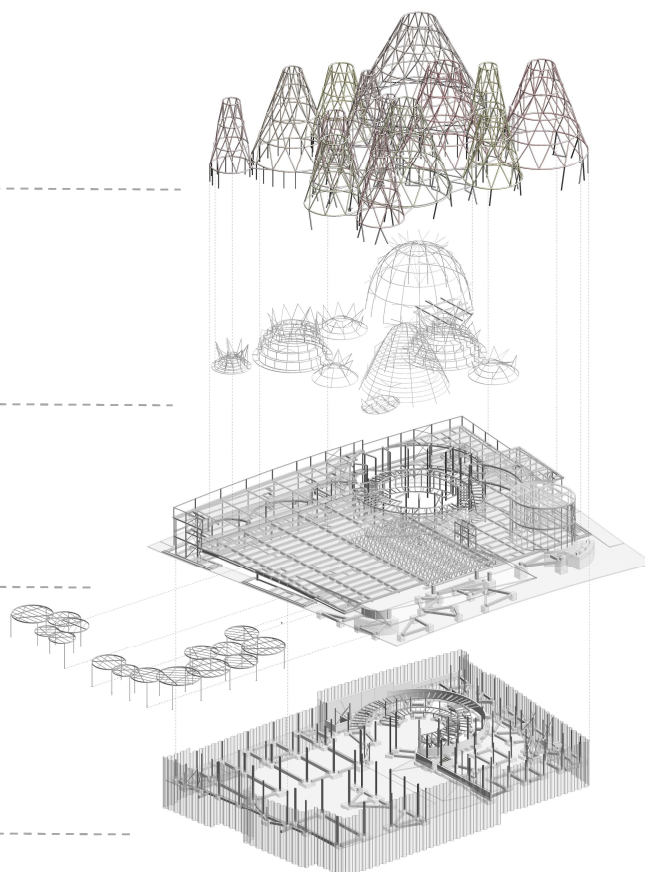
Modelo BIM para el desarrollo de proyecto y proceso de construcción
